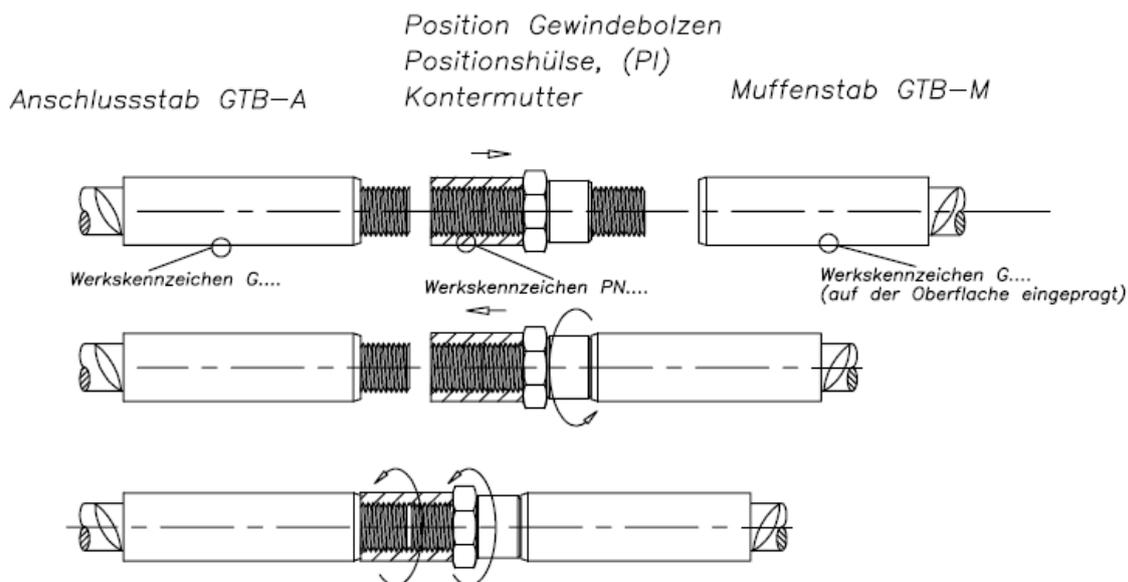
POSITIONSVERBINDUNG (PI) (Alternativ)
